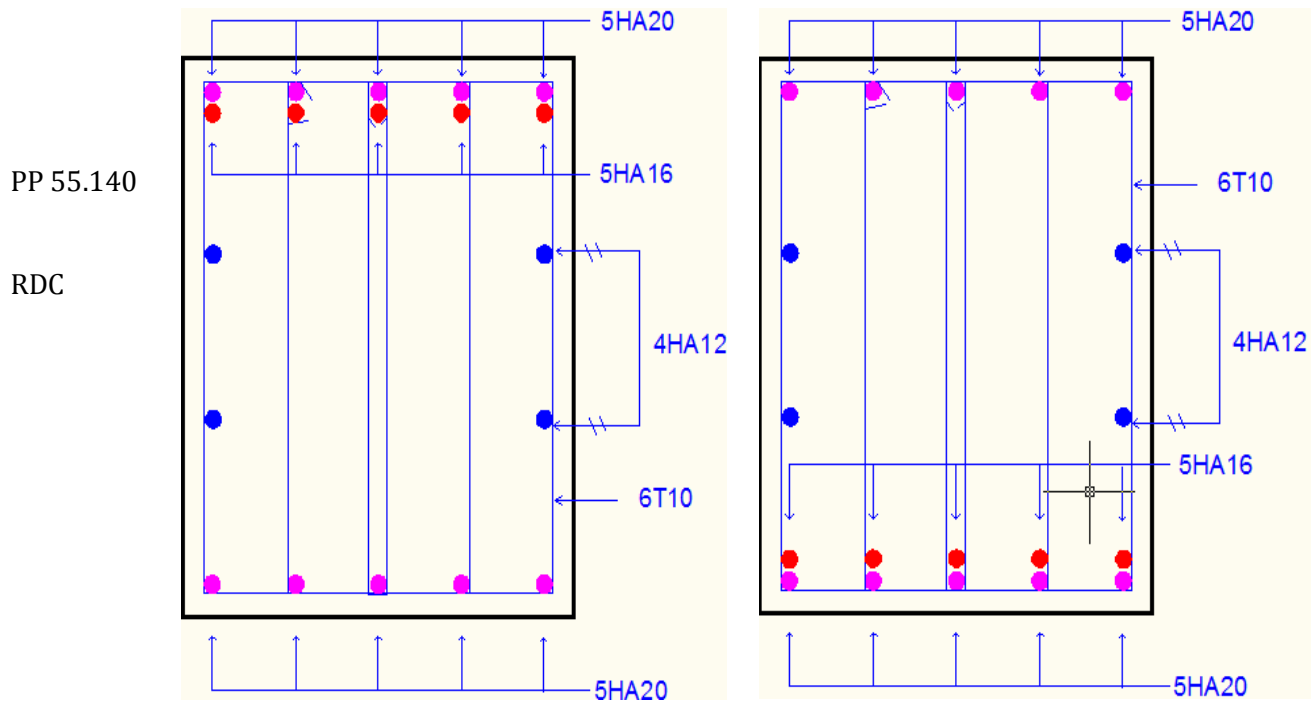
Section de ferrailage des poutres principale 55.140 RDC.
